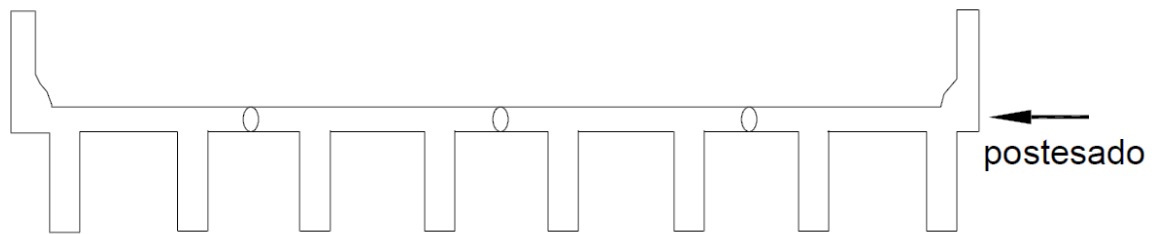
Sección transversal de puente con vigas doble T con conectores de corte (AASHTO, 2007)
